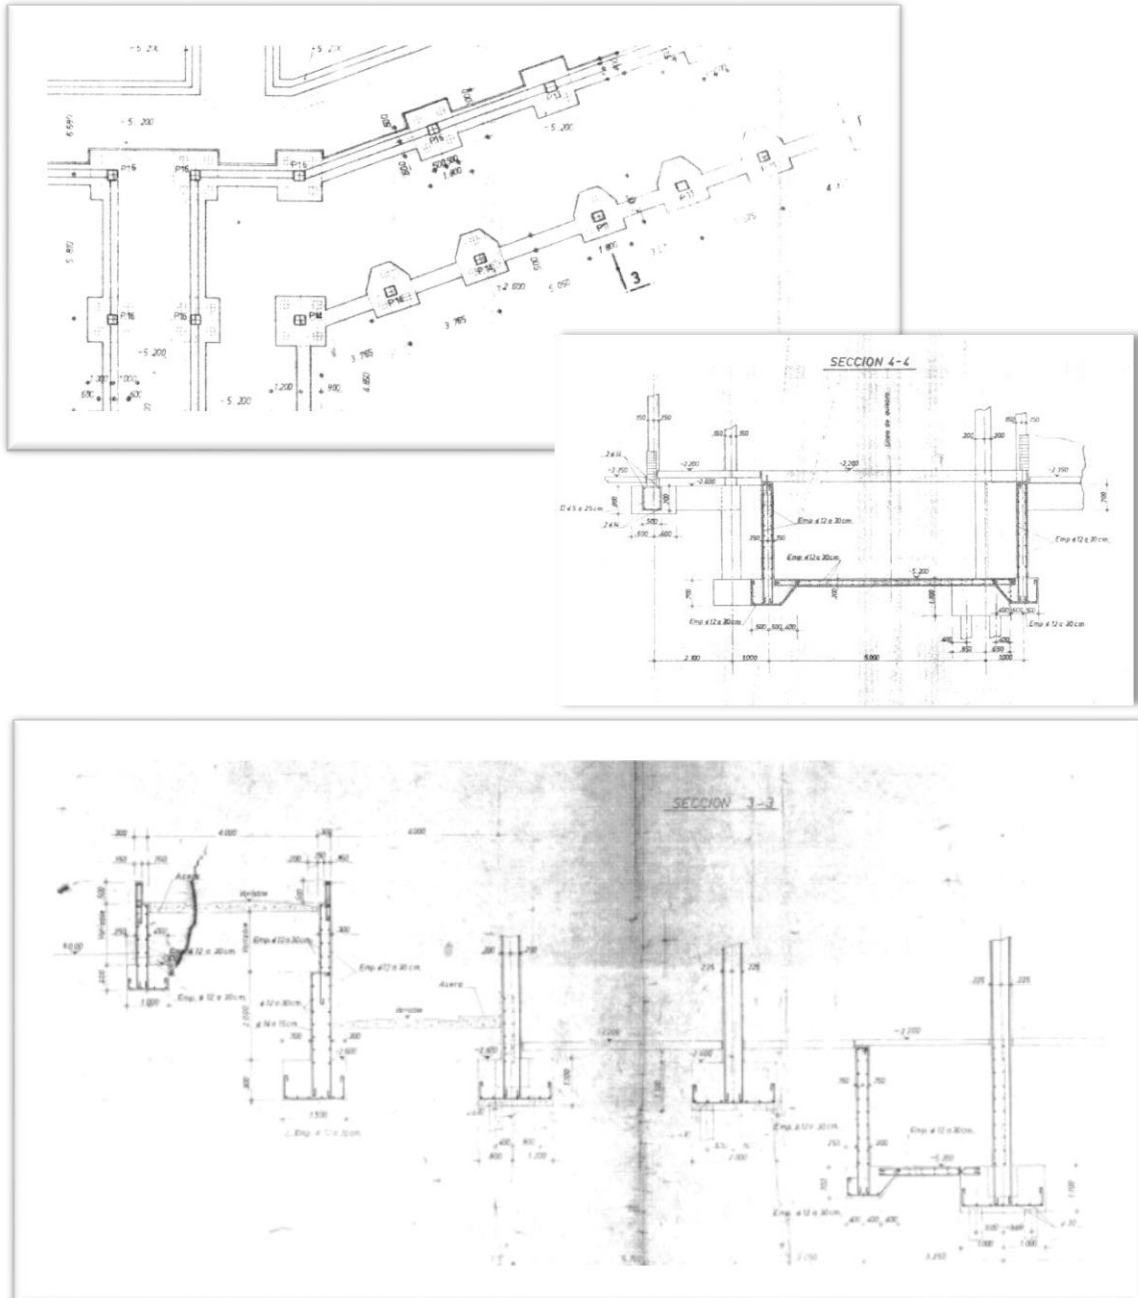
Detalles de la cimentación. Fuente: planos originales de 1970
